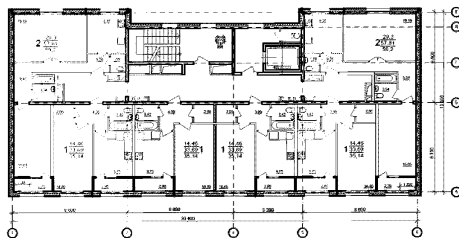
Экспериментальная блок-секция с широким шагом несущих конструкций. План типового этажа
